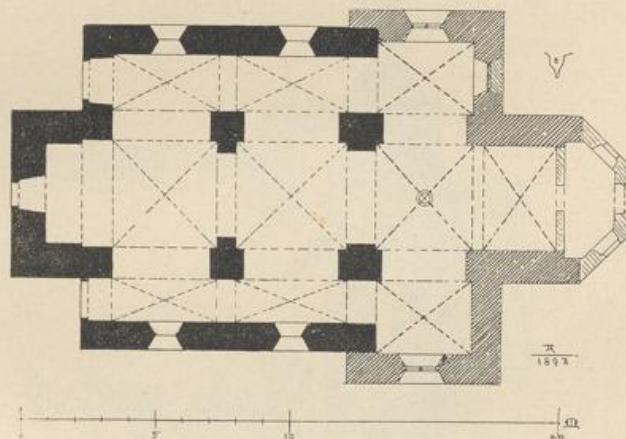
Lieberhausen. Grundriss der evangelischen Pfarrkirche.
